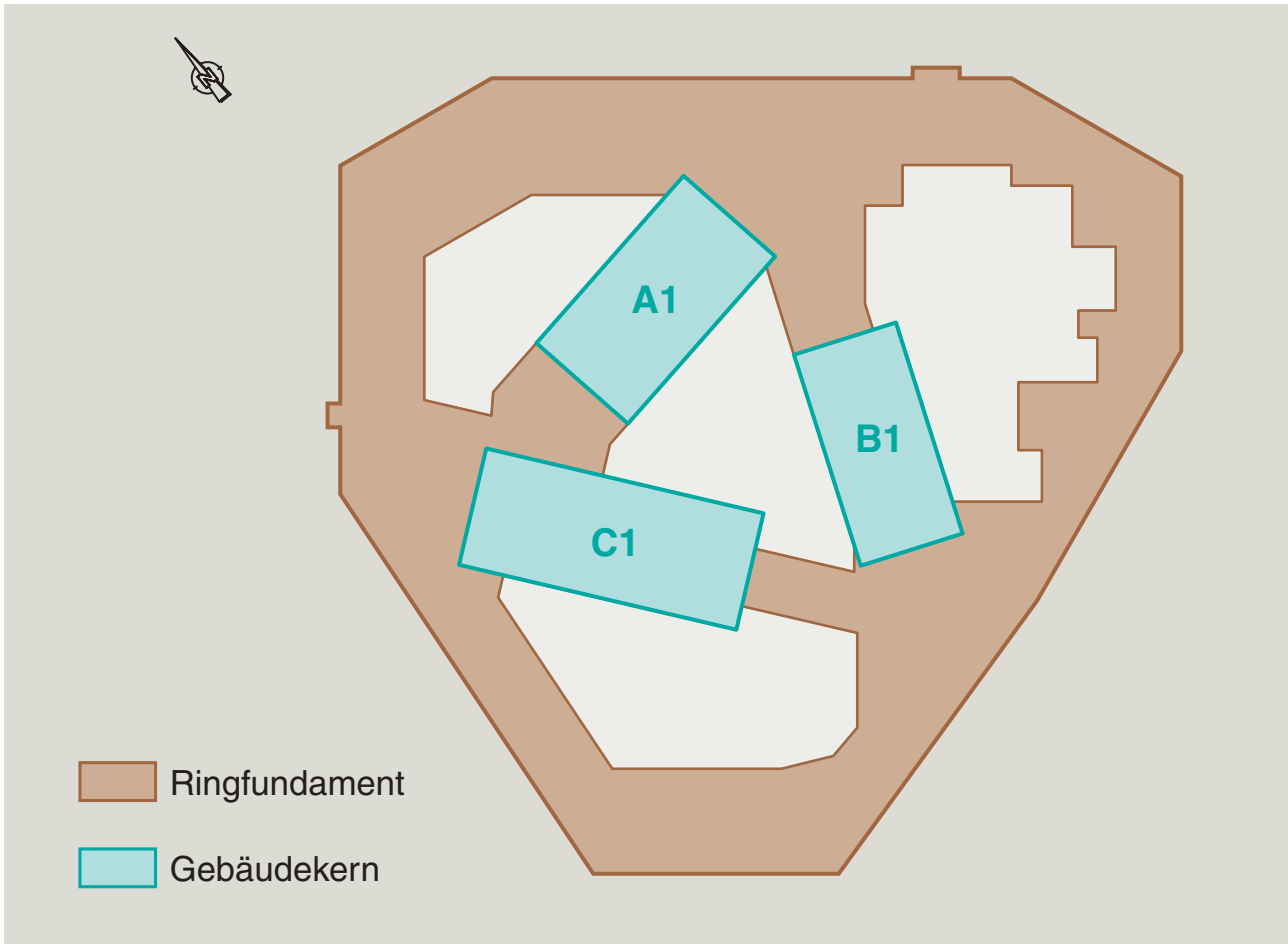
Schematischer Grundriss des Museumsgebäudes
